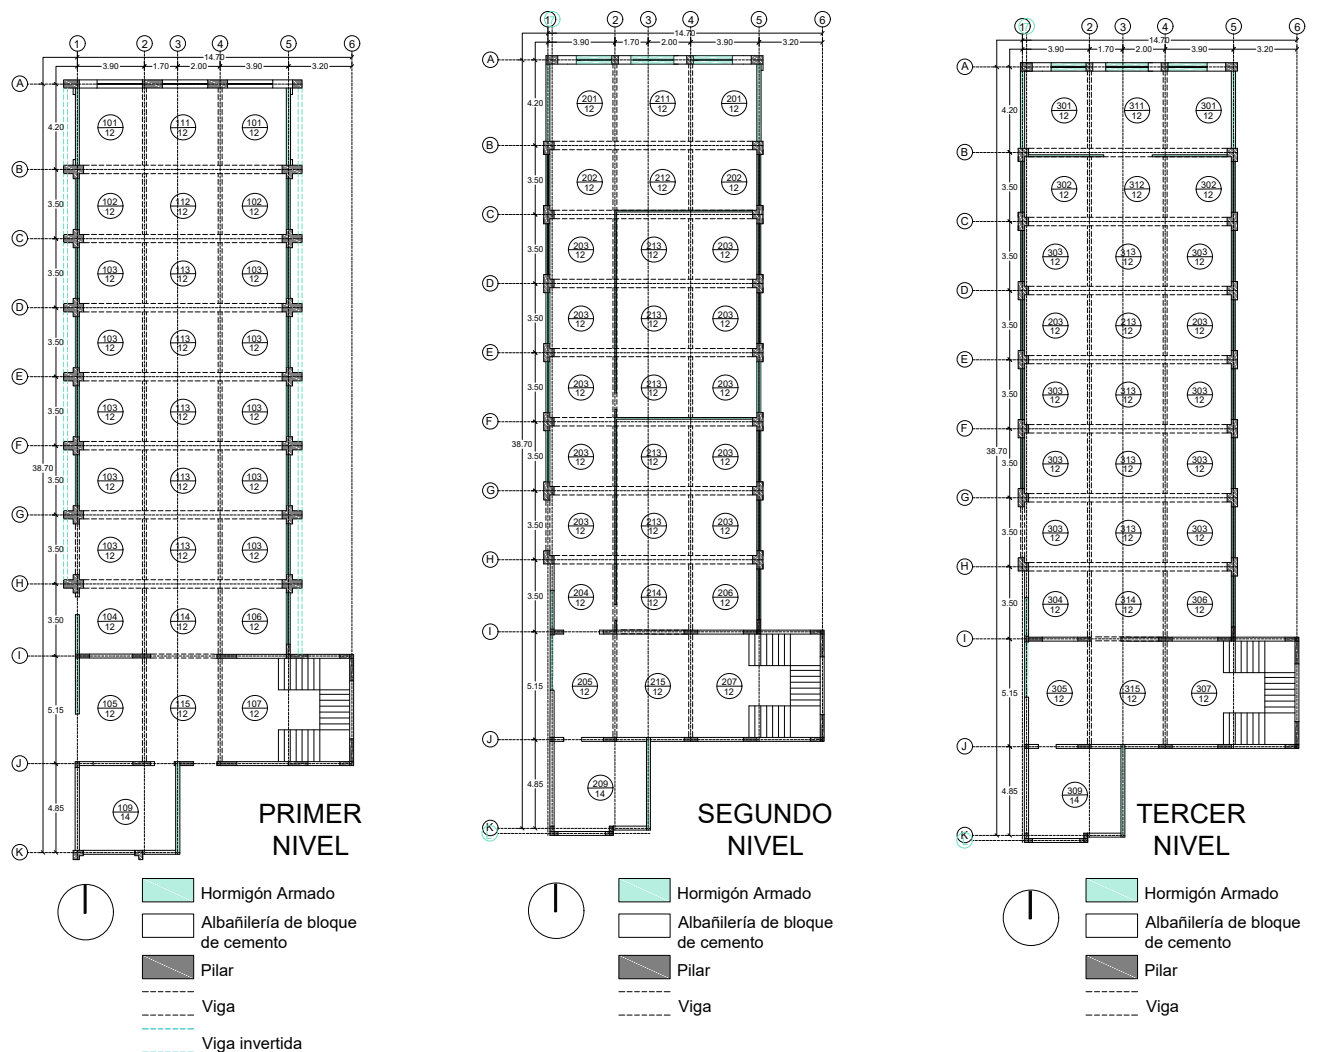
Plantas de Estructura, Escuela de Minas. Fuente Elaboración propia.
